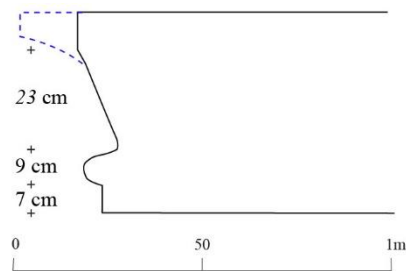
Dimensions des moulures des blocs 5001, 5002 et 5049.
